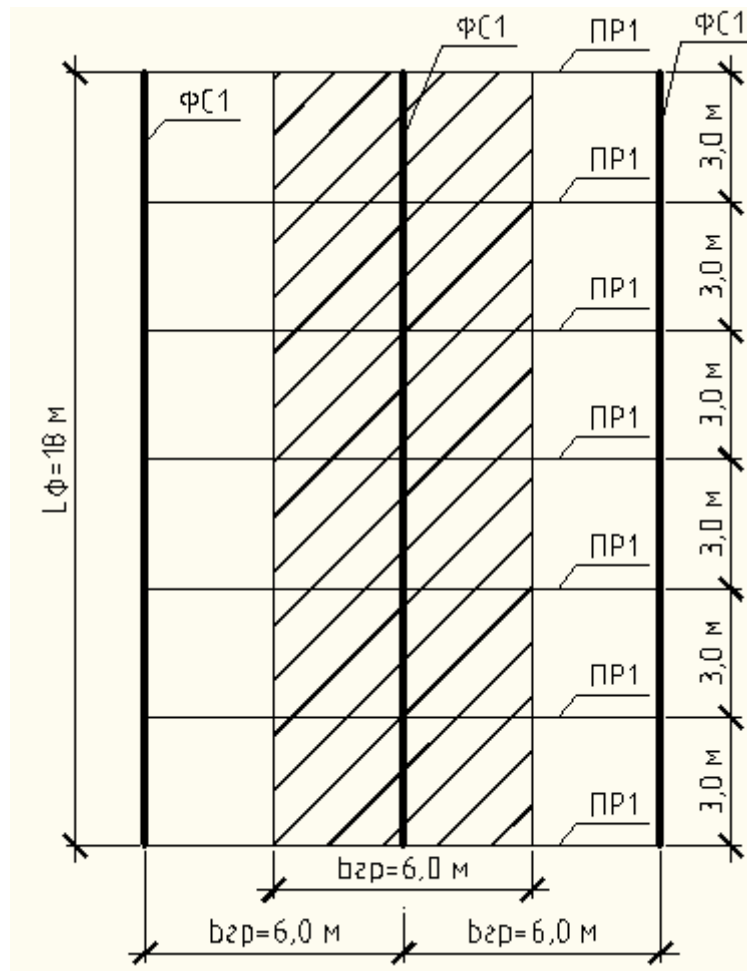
Схема расположения стержневых ферм перекрытия и прогонов по ним
